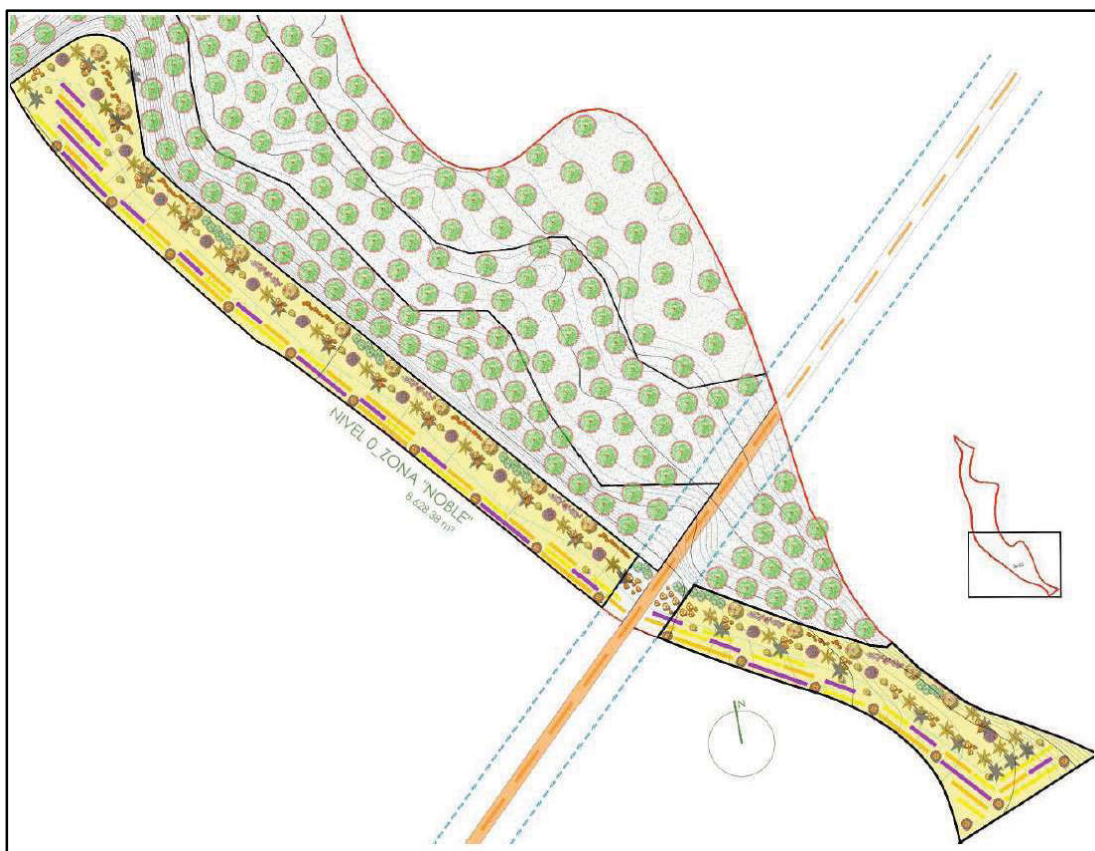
Proyecto en el ámbito de la DC-02 ZONA NOBLE.
